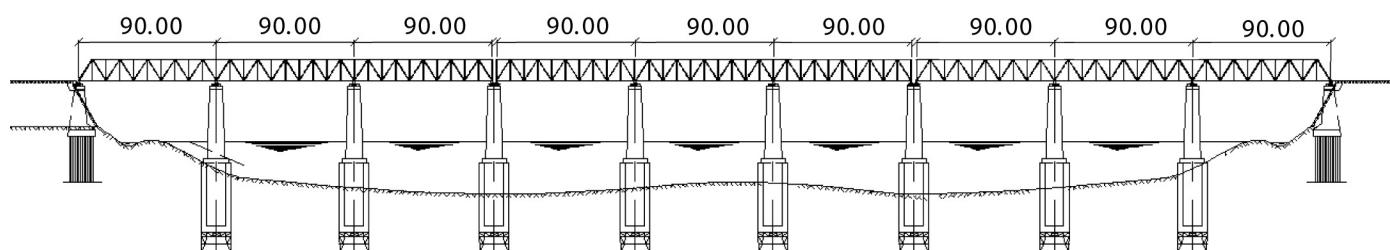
a : Elévation et coupe longitudinale du pont-rails de Marazeek.
